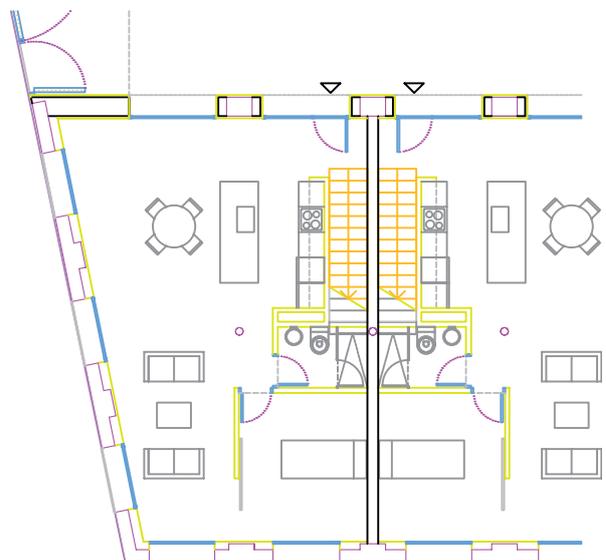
Planta d'arquitectura original. | Planta de arquitectura original.
